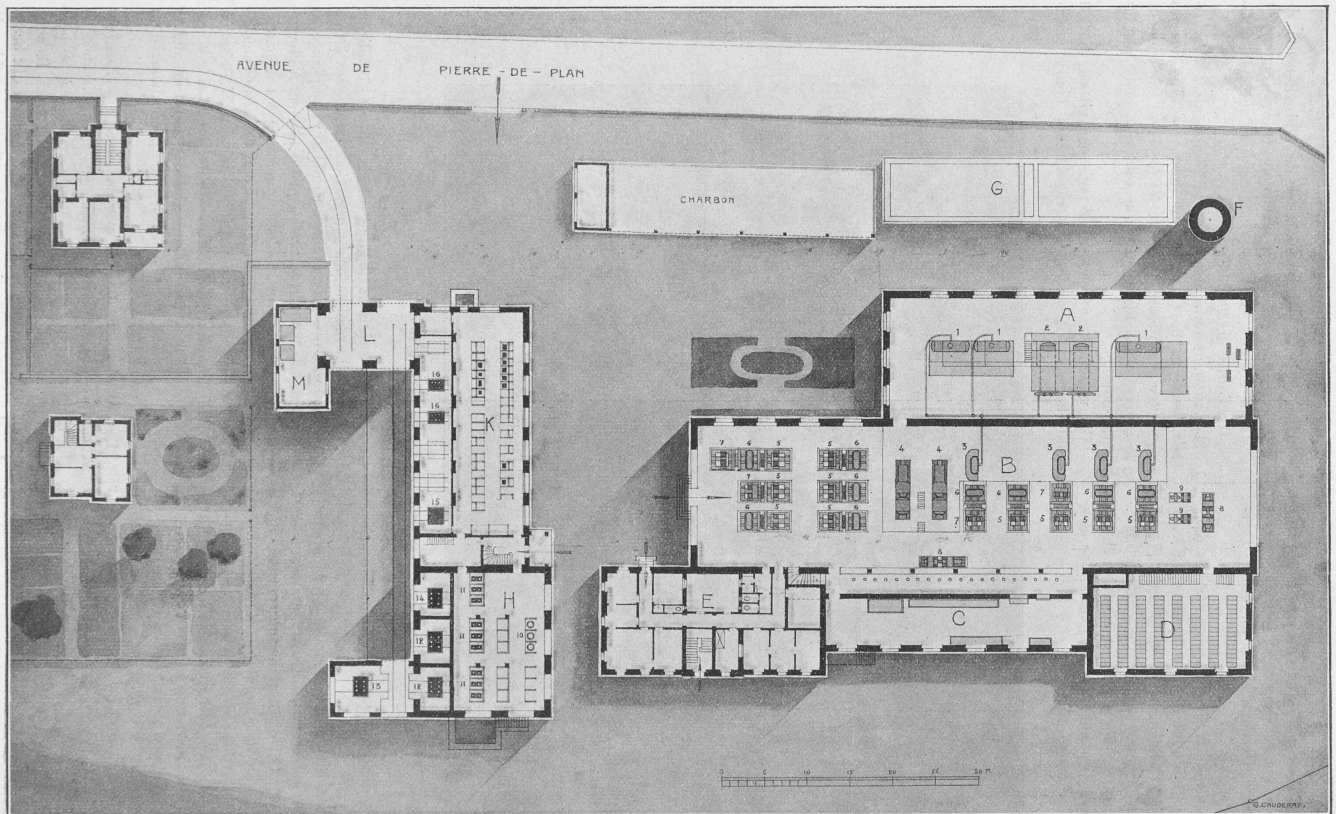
Plan général de l'usine de Pierre-de-Plan.
